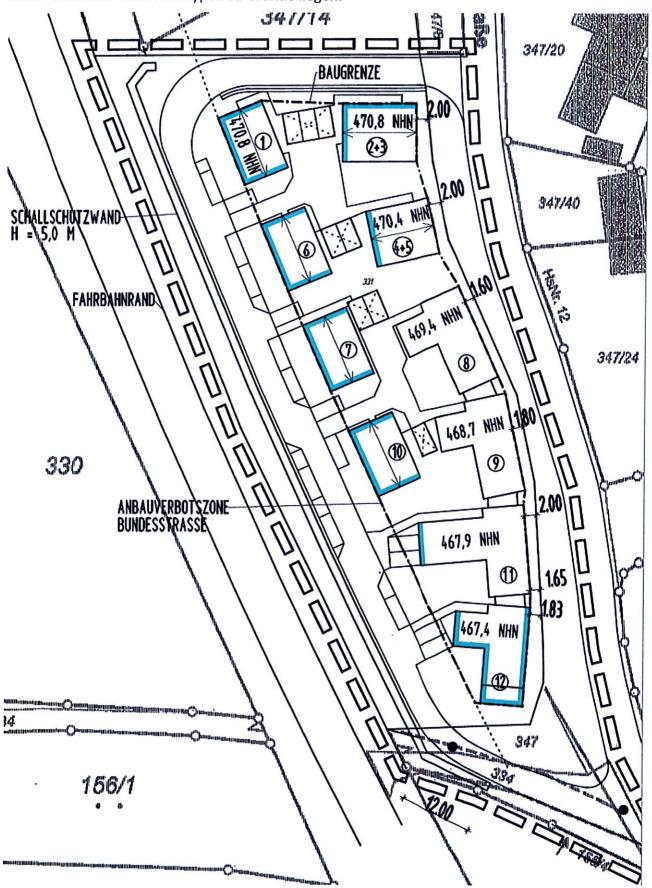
Auszug Lageplan mit Planbebauung, ohne Maßstab, Stand 14. Mai 2019
